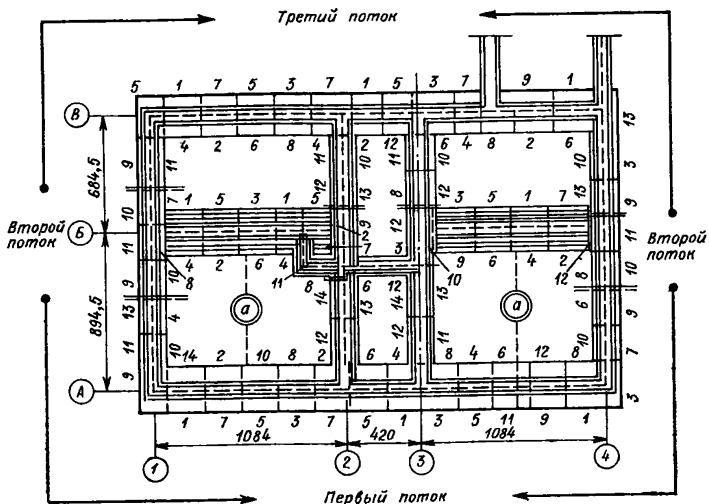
Схема разбивки фундаментов здания на захватки
